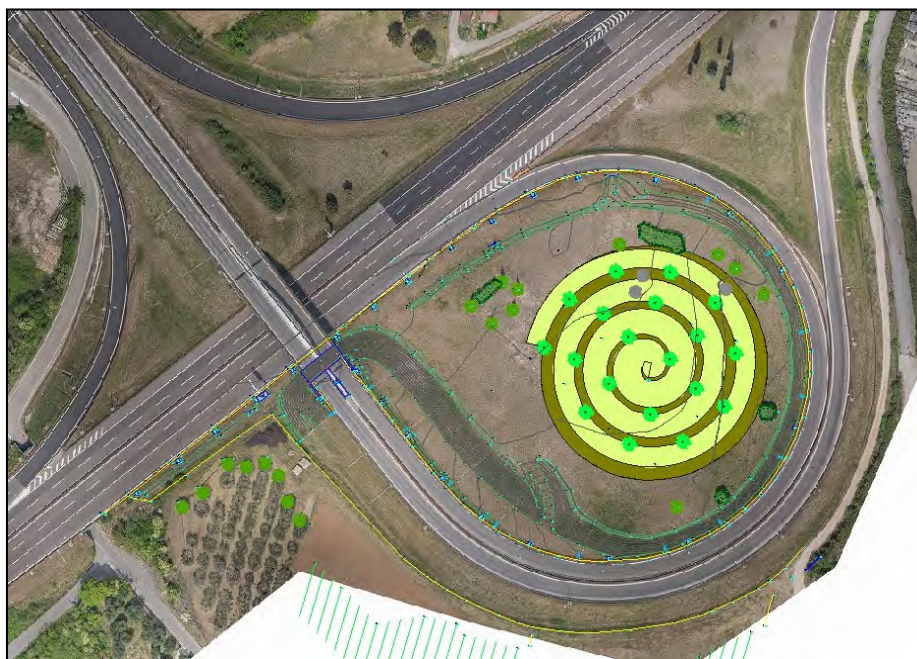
Planimetria schematica dell'intervento nello svincolo di Affi
